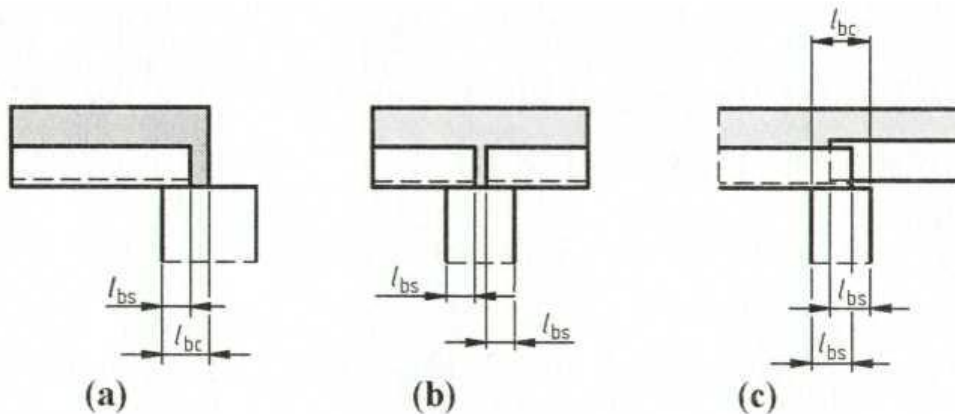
Мінімальна довжина обпирання: а) одностороннє спирання; б) двостороннє спирання; с) внапусток на опорі
